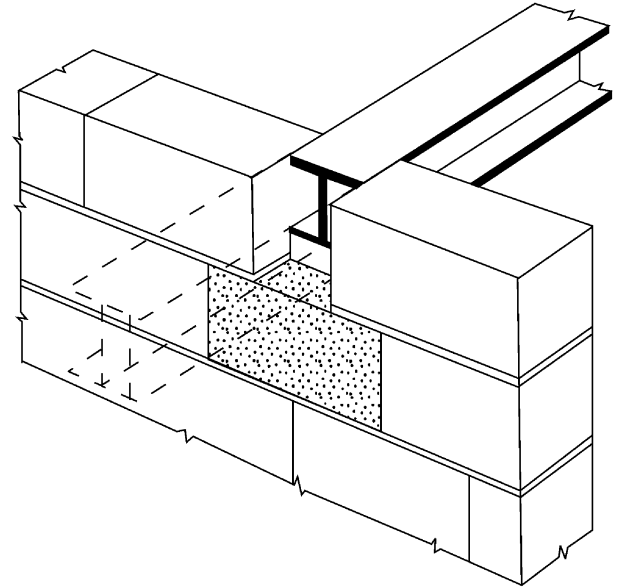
Apoyo de cargas puntuales. Sobre zuncho armado.
